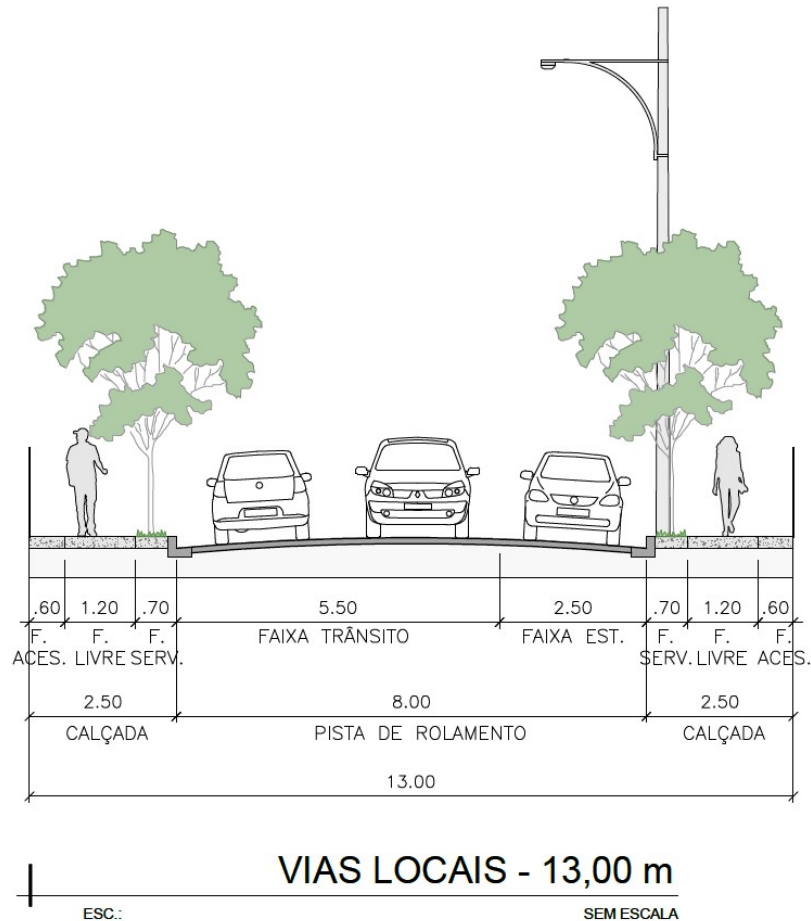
Seção Transversal das Vias Locais em Loteamentos Empresariais
